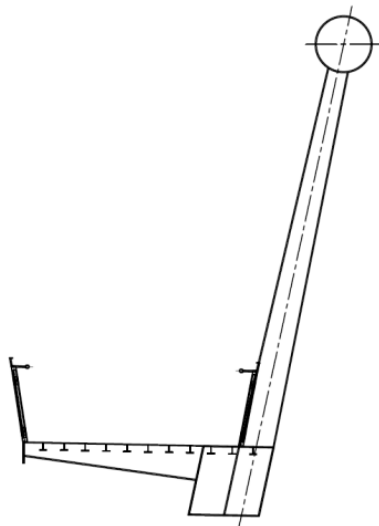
Przekrój poprzeczny przez przęsło łukowe – wersja pierwotna projektu
